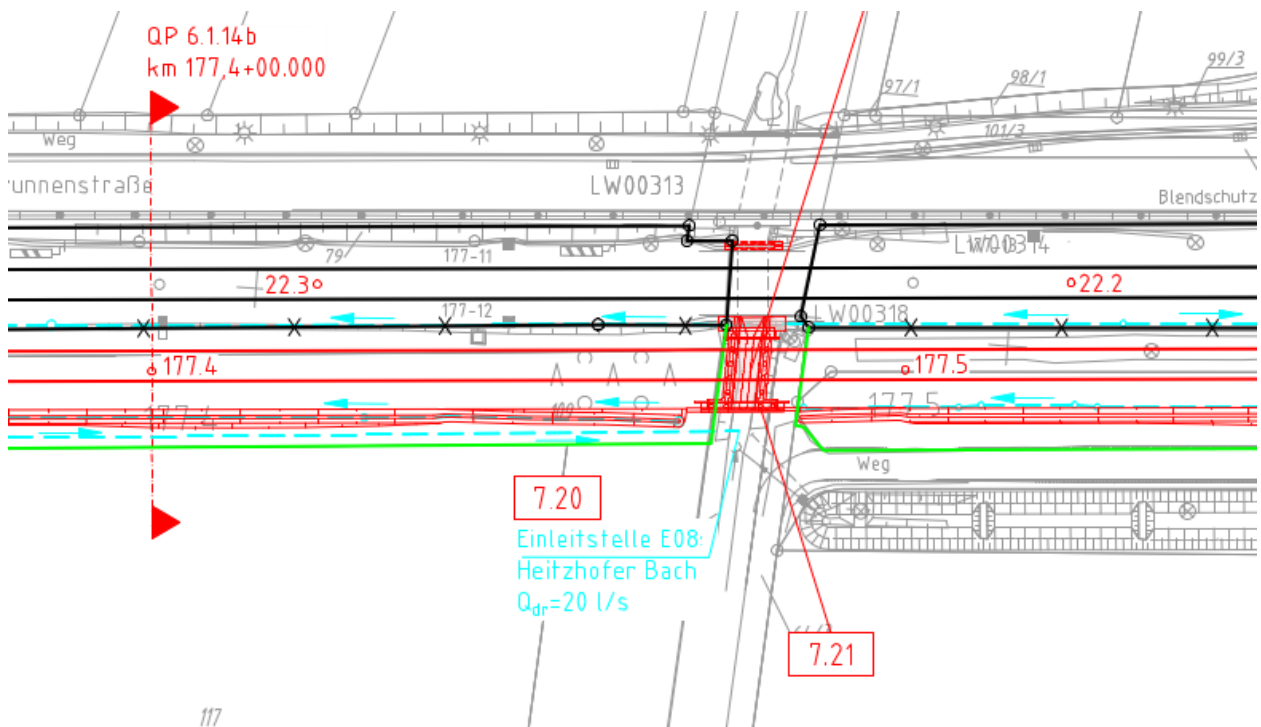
Lageplan der EÜ Heitzhöferbach
